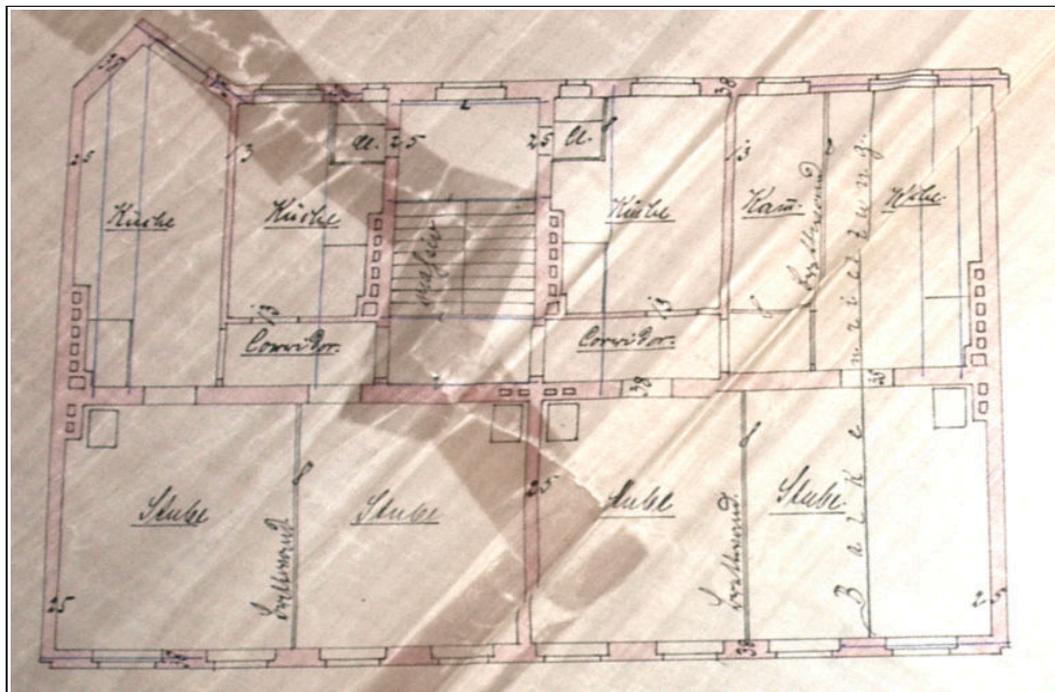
Grundriss 3./4. Geschoss VH
